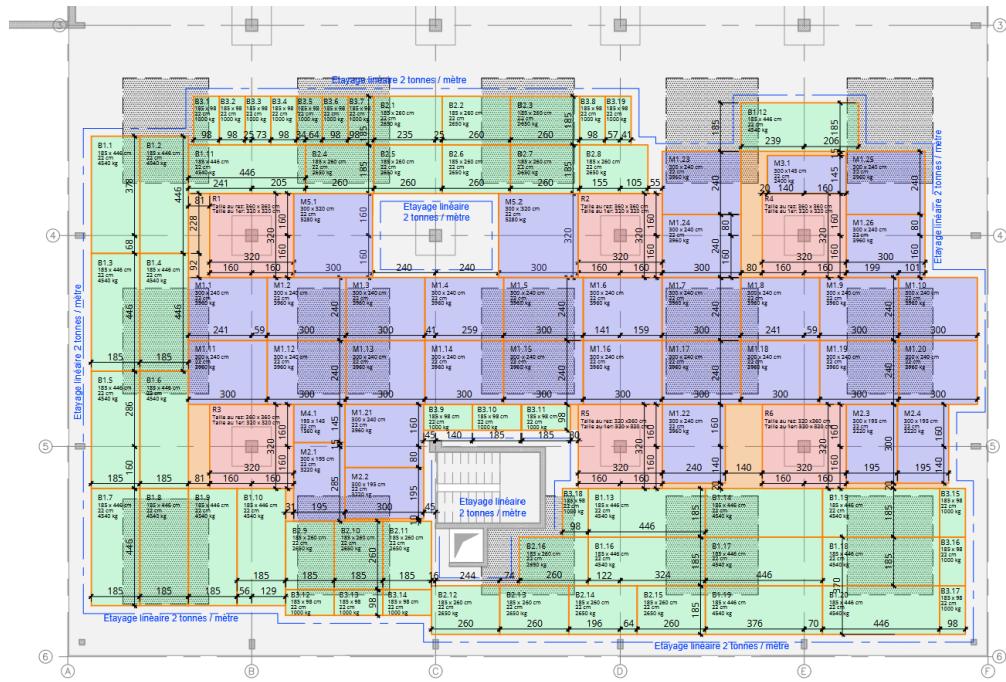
Plan de découpe de la dalle sur RDC du bâtiment existant
